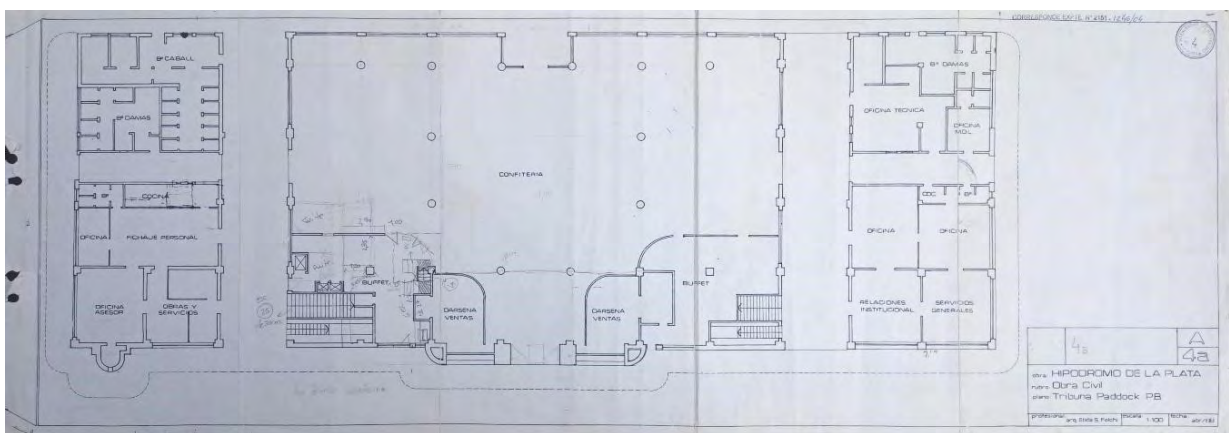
Plano Tribuna Paddock. Planta Baja. 1988. Fuente: Archivo Hipodromo de La Plata.
